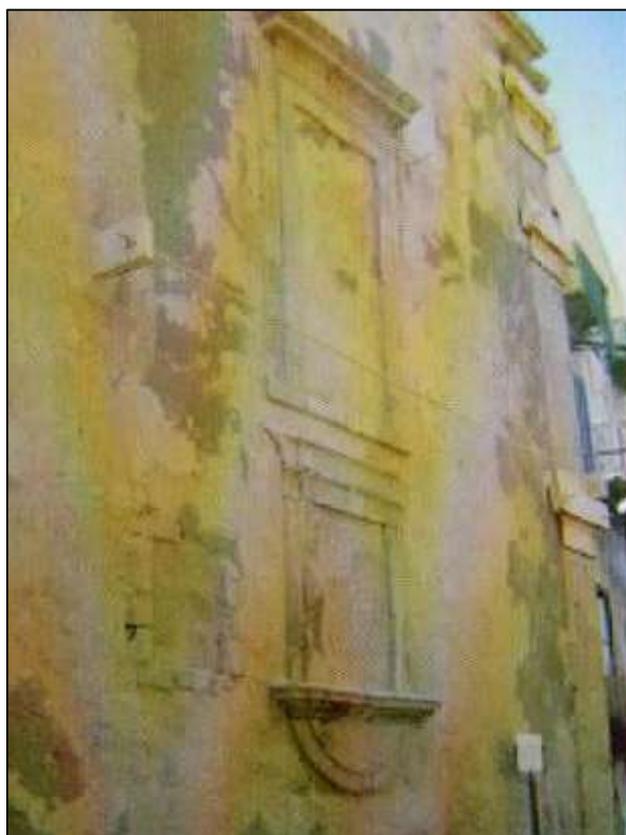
Finestra destra esterna prima del restauro con apertura murata (fonte: progetto arch. E. Giliberti)
